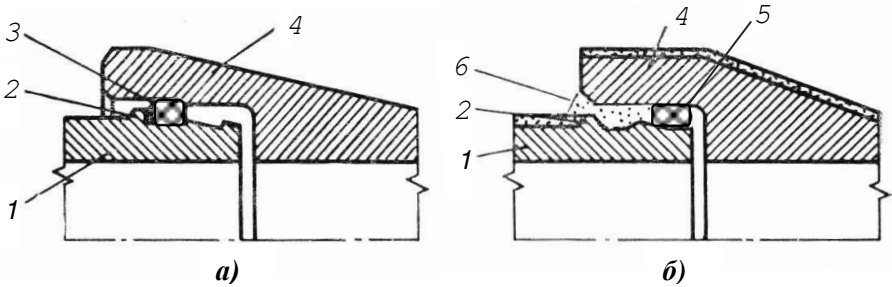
Розтрубні з'єднання бетонних і залізобетонних труб
